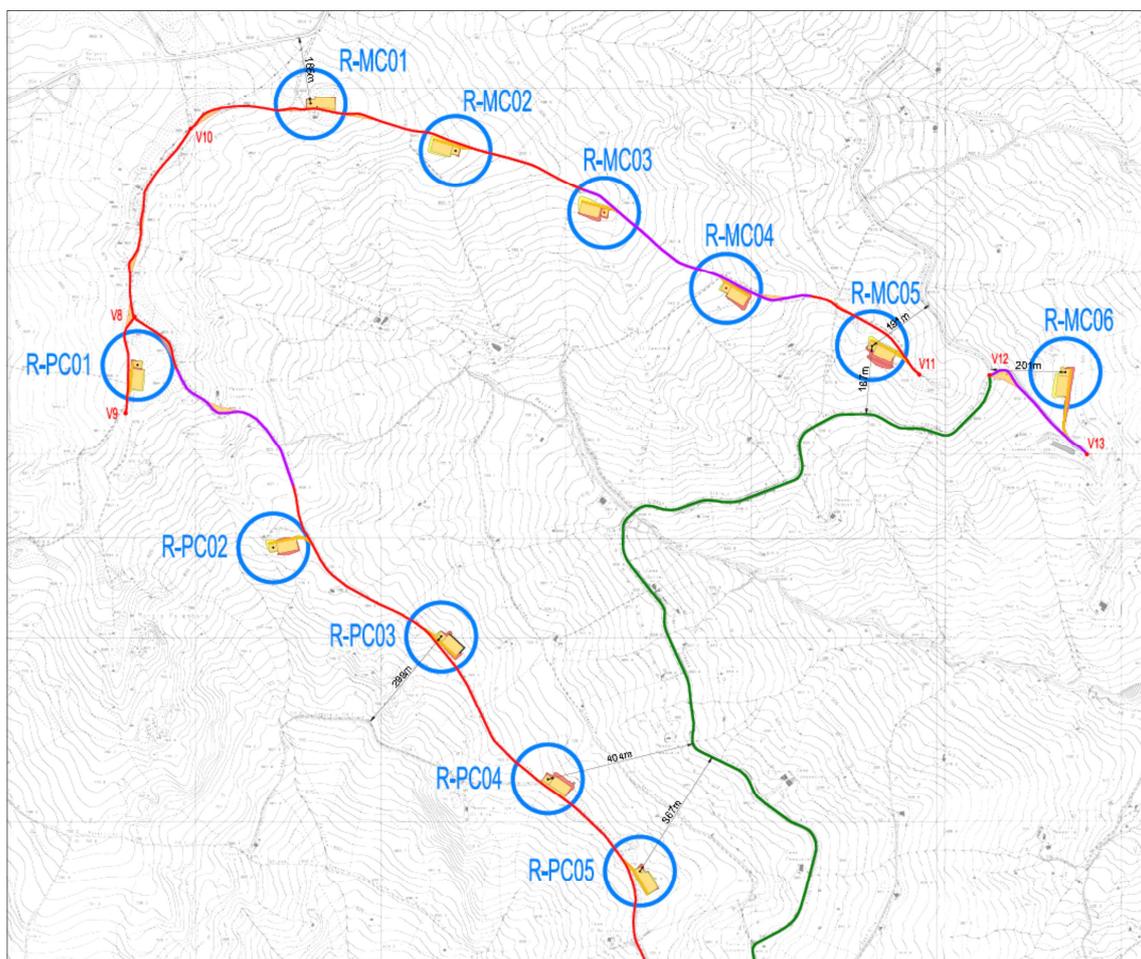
Planimetria piazzole e viabilità d'impianto (area nord)
